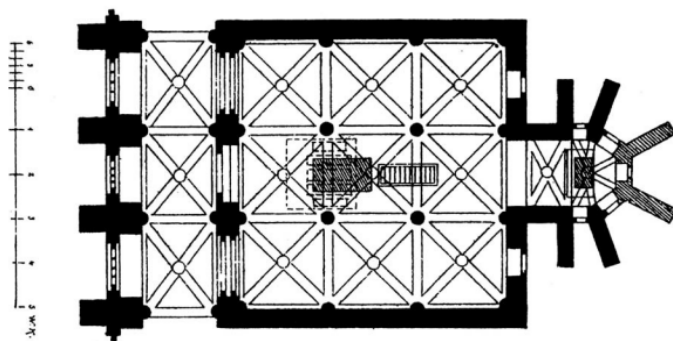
Stift Neuberg, Kapitelsaal, Grundriss mit Gruft
